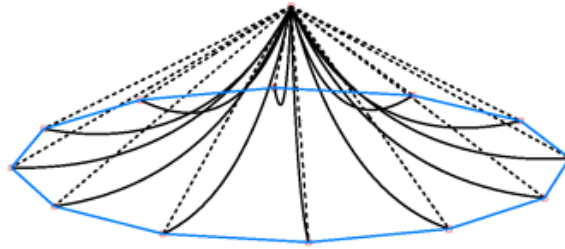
Rotationsfigur mit Tiefpunkten am äußeren Auflagerrand, Form (10)
